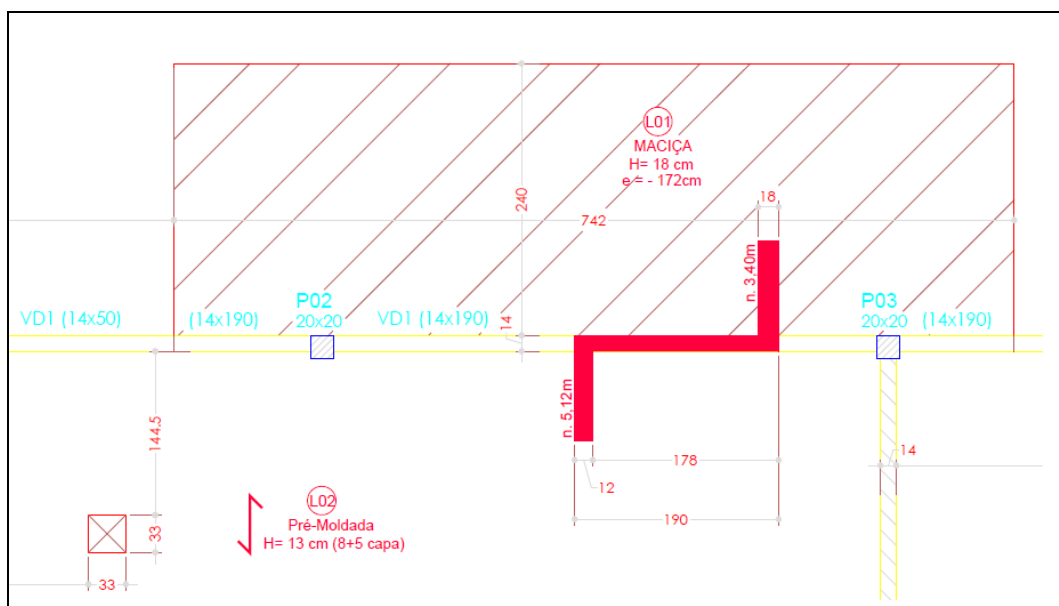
Vista do pilar de apoio com seção 20 cm x 20 cm
